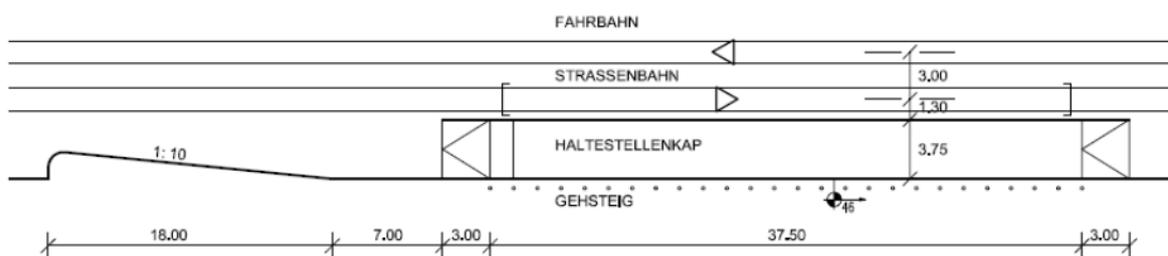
Haltestelle mit Fahrbahnanhebung [38, p. 51]
